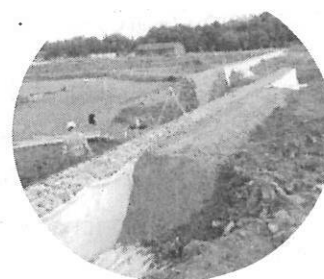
Photographie d'un chantier pour la construction de gîtes pour les hirondelles de rivage @Ville de Lille
